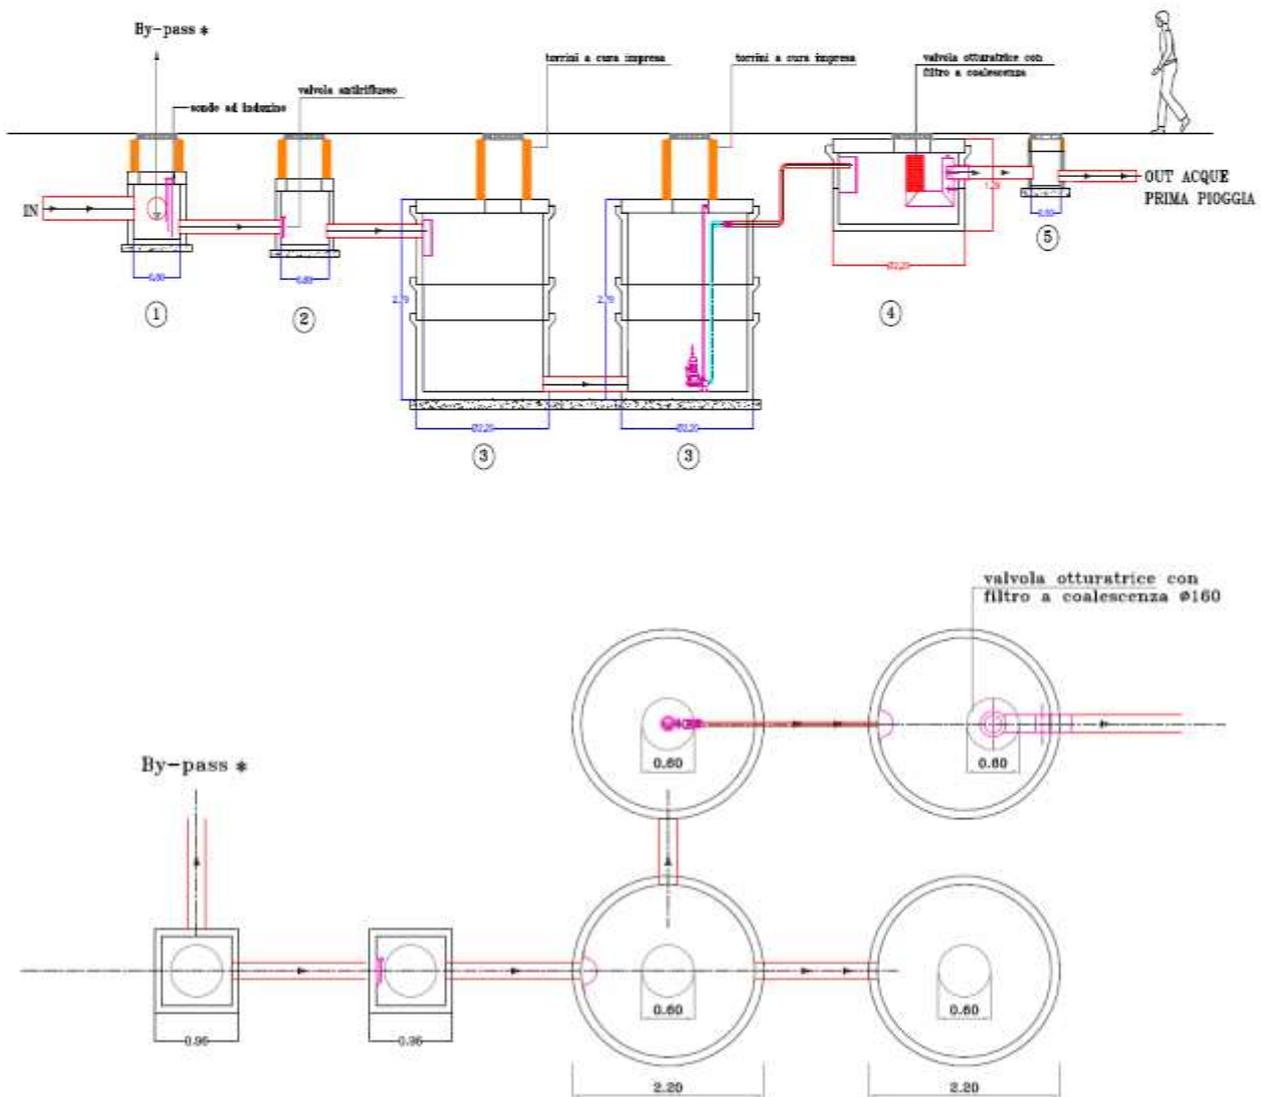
Pianta e Prospetto della vasca di Prima Piovvia (mod. Euremec)
